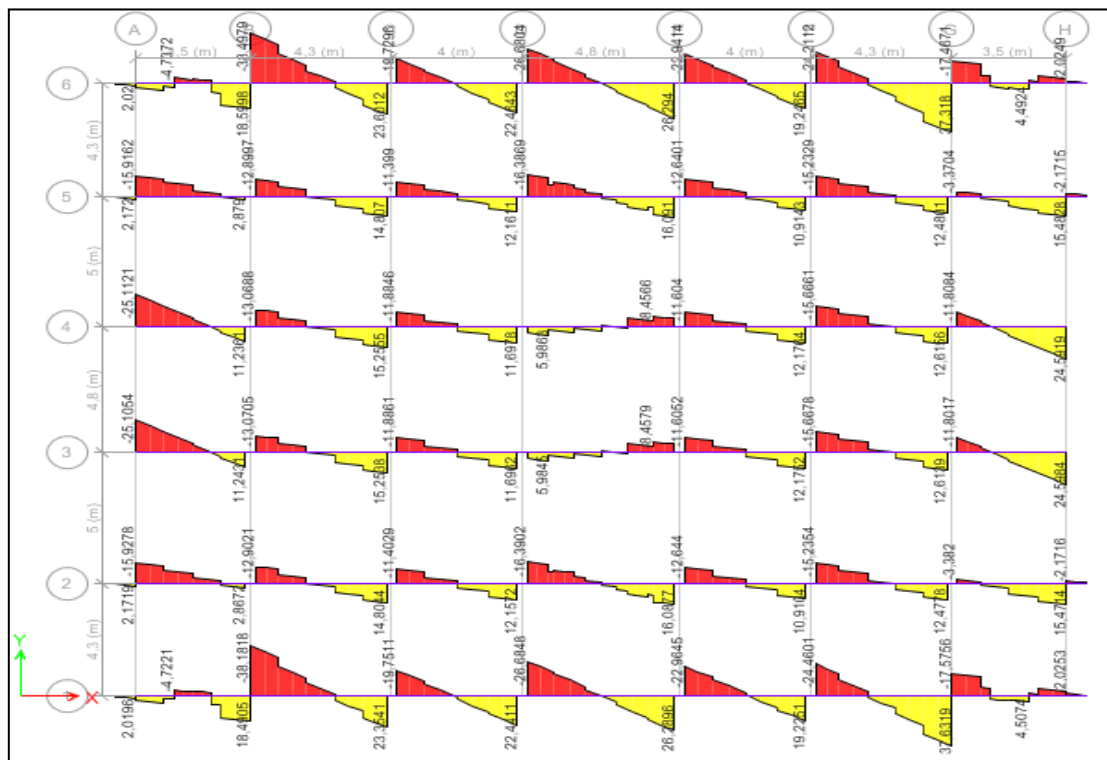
Effort tranchant des poutres secondaires (ELU)
